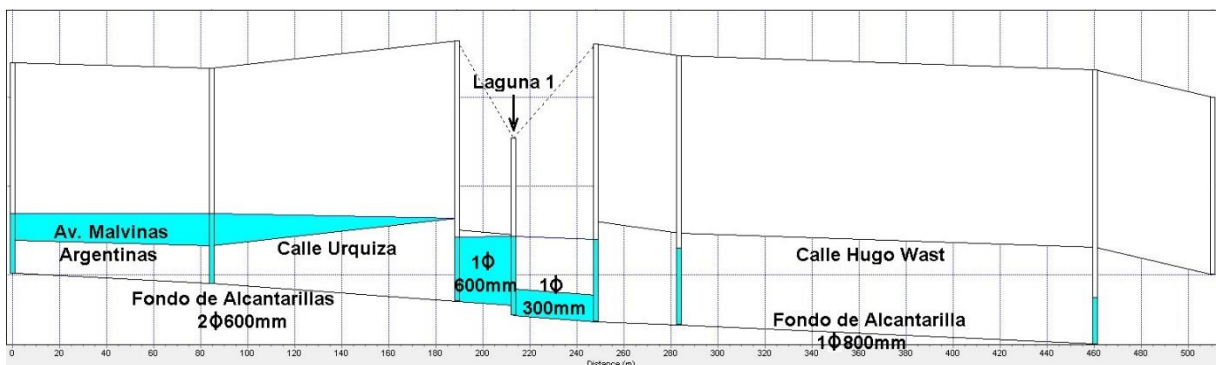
Perfil Longitudinal. TR10-30min. Situación Futura.
